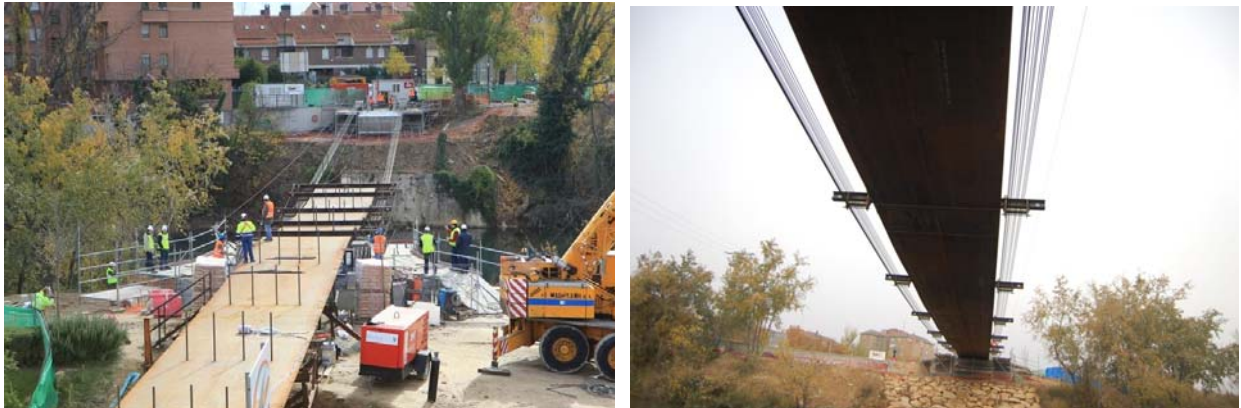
Vista de la pletina sobre castilletes y los cables auxiliares durante el lanzamiento.
